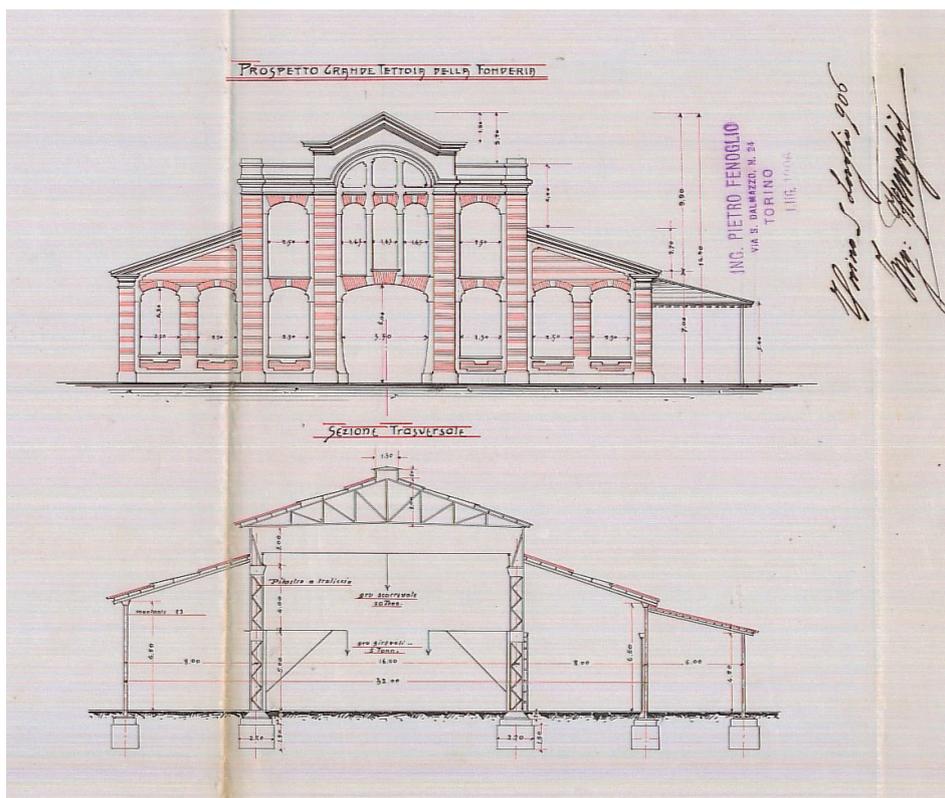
Prospetto e sezione trasversale della fonderia dello stabilimento Ballada. [ASCT, PE, 313/1906]
